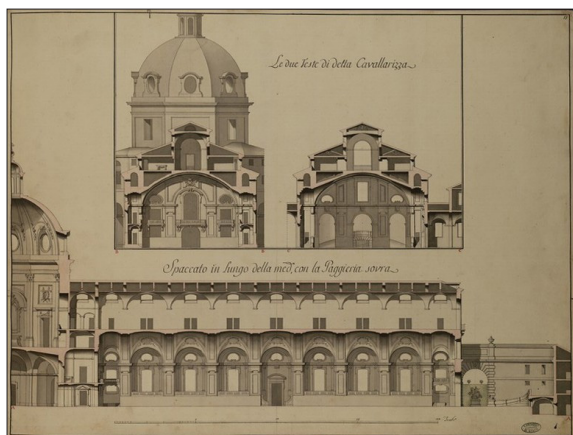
Benedetto Alfieri, Piante e sezioni della nuova Cavallerizza, 1763
